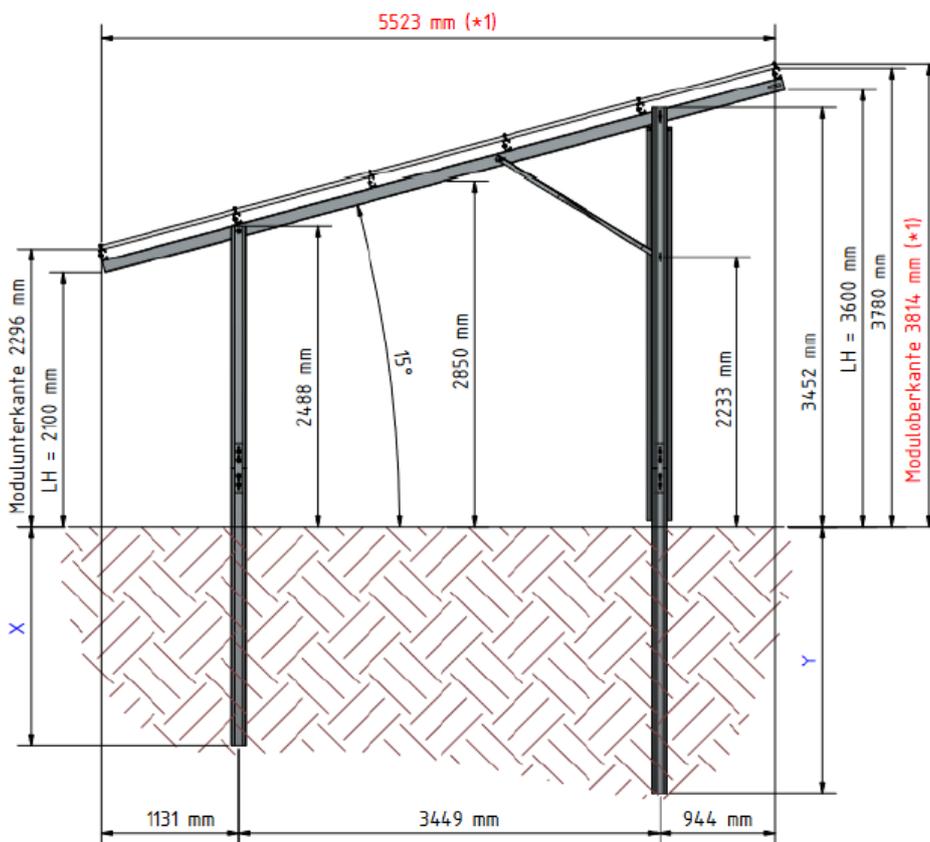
Modulquerschnitt (SUNFarming GmbH)
